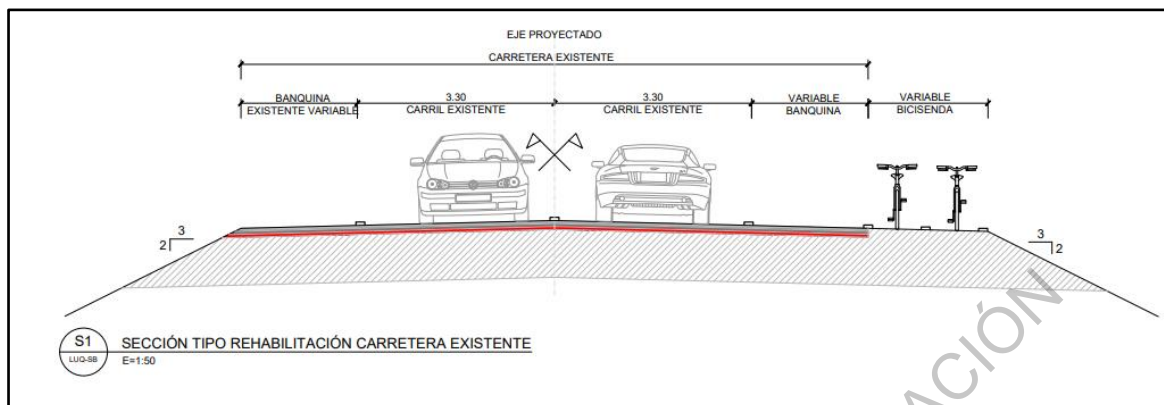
Sección tipo – Tramo 14 Rehabilitación
